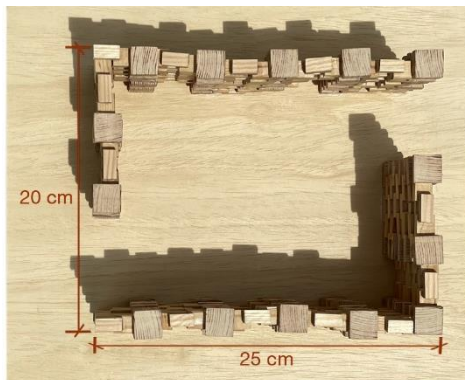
Vista en planta de la maqueta con las medidas. Autor: Elaboración propia.
